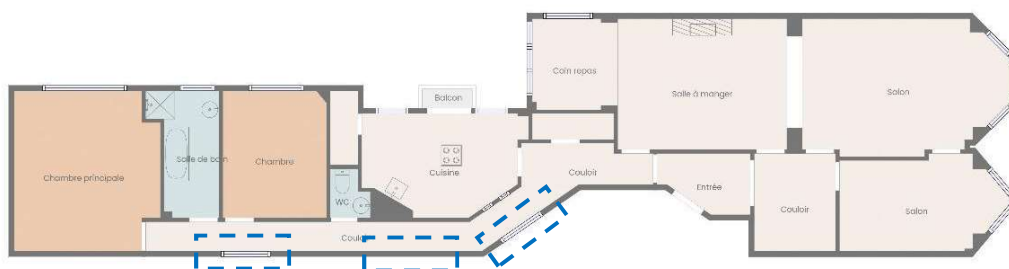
Plan schématique d'un appartement type, immeuble voisin n°29
